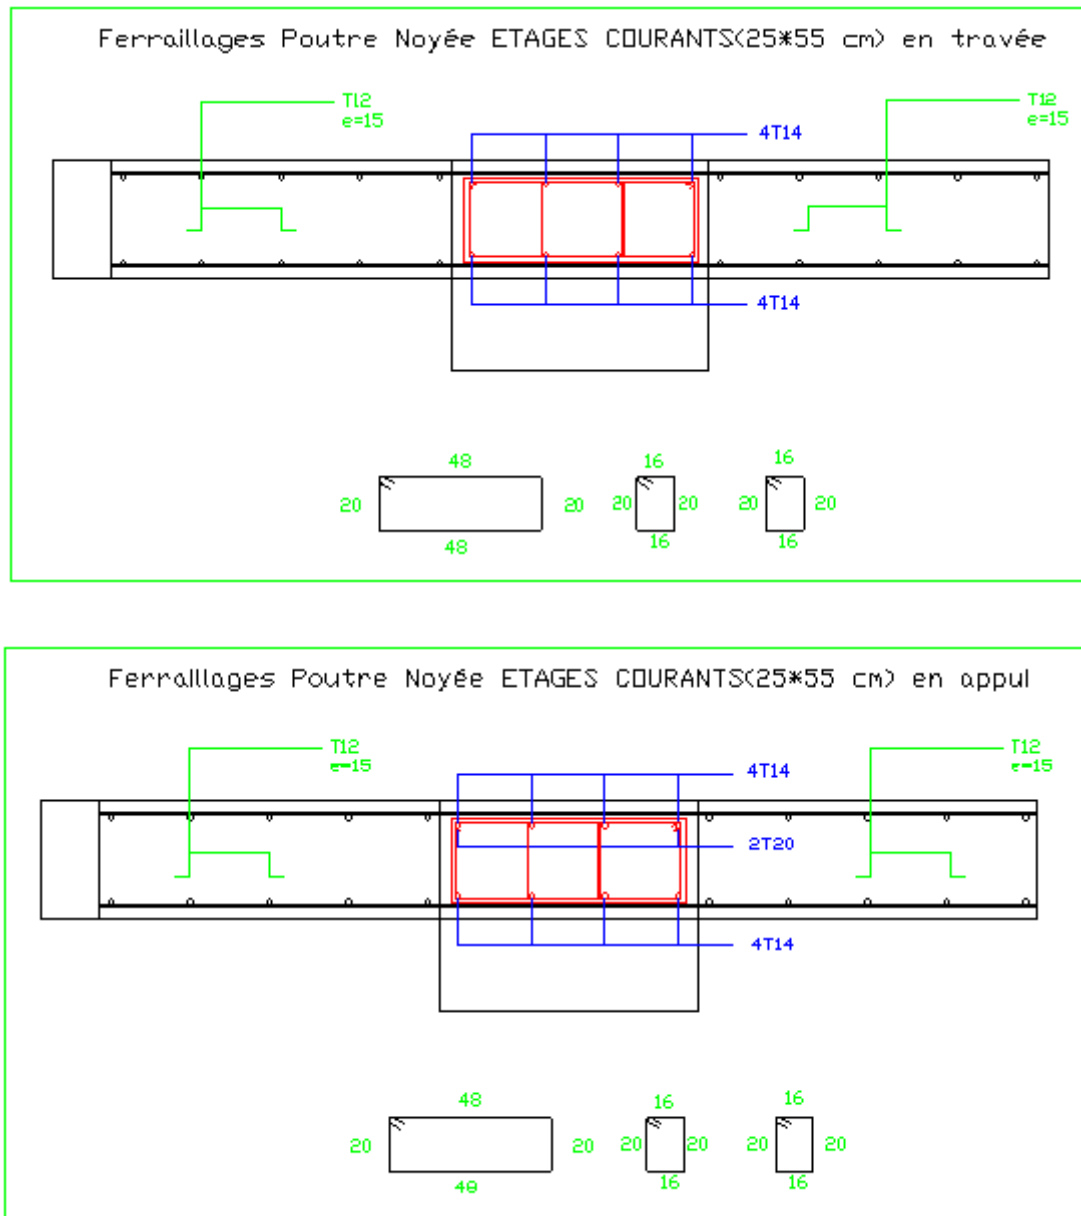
Ferraillage poutre noyé (25*55) appui et travée étage courant
